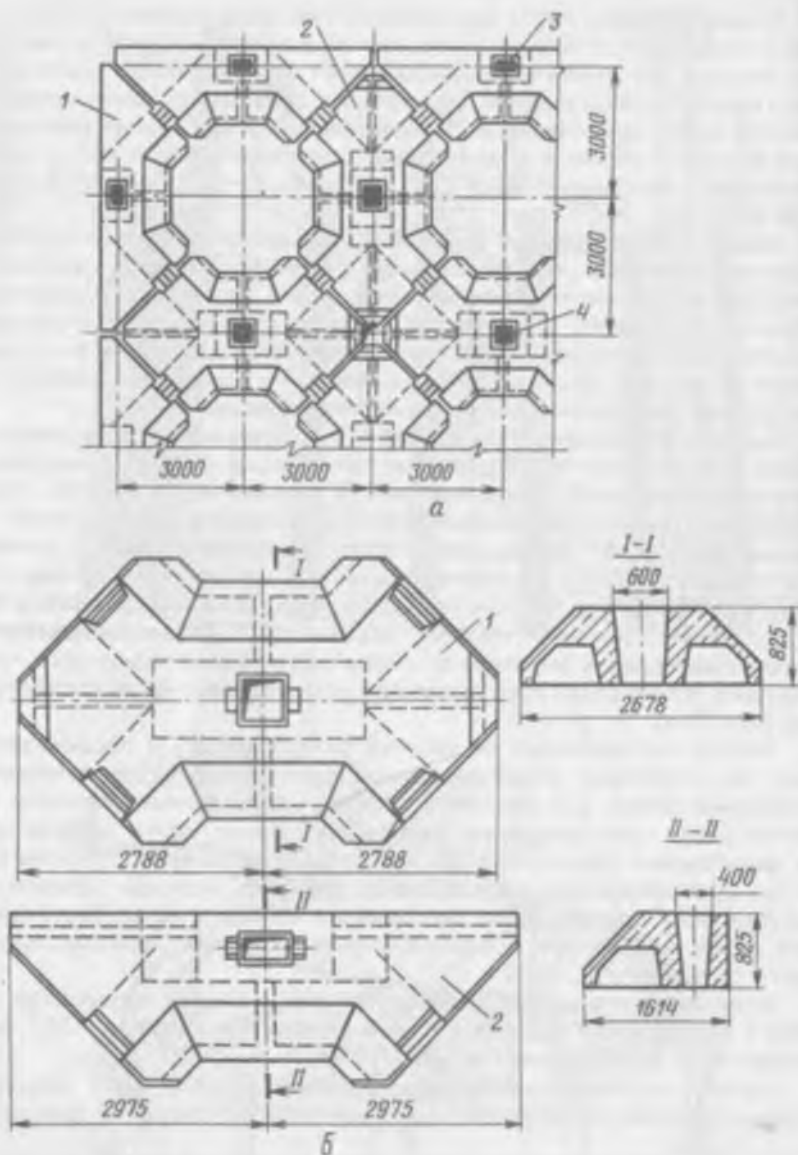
Перекрытие подсилосного этажа силосного корпуса СКС-6 из сборных железобетонных блоков:
